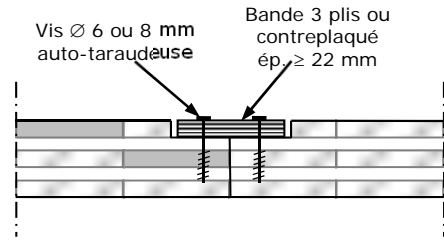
Assemblage par interposition d'une bande de liaison (joint languette)
